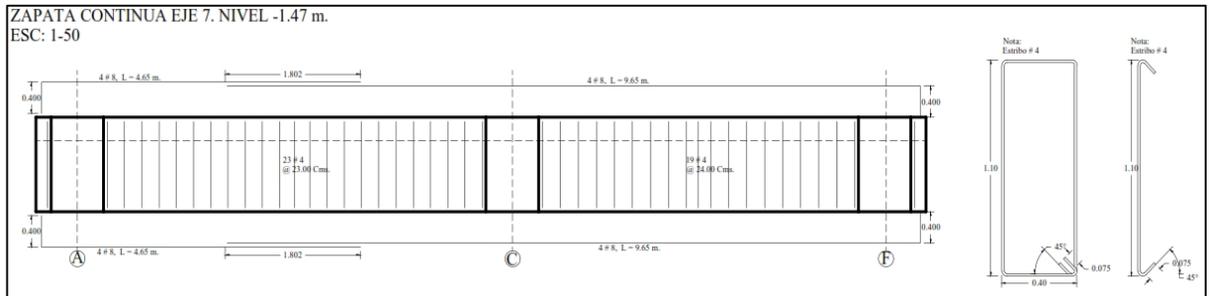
, Detalle viga eje 7, Fuente: Constructora Open House
